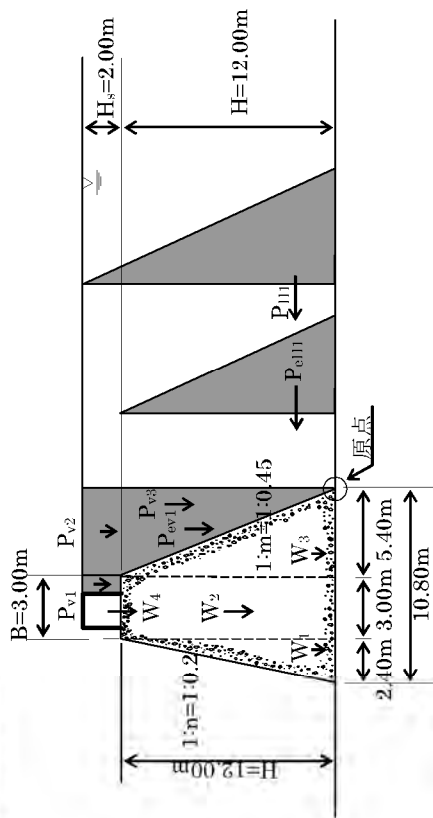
砂防堰堤に作用する力 (土石流捕捉後の湛水時)
